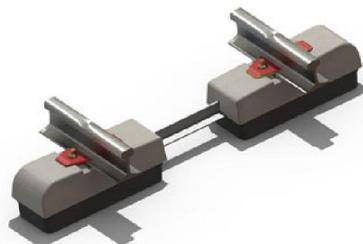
Traviesa bibloque Stedef. Railtech Sufetra.
